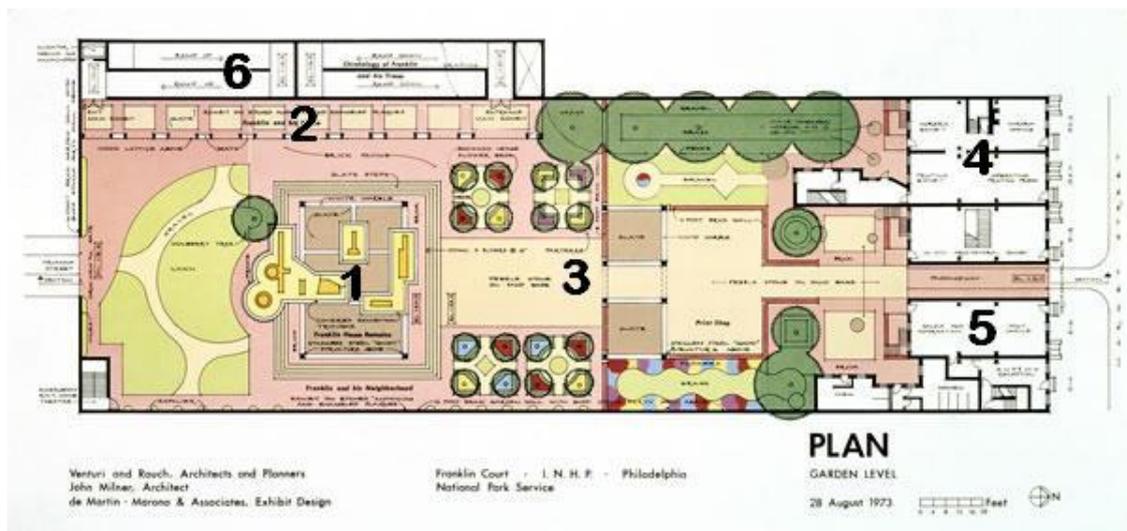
Franklin Court . Planta do pavimento térreo.
